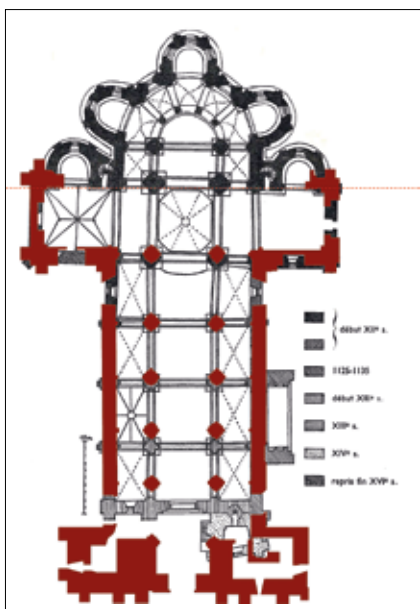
Sobreposição da planta da Sé com a de Beaulieu (mesma largura: relação 10:8).
